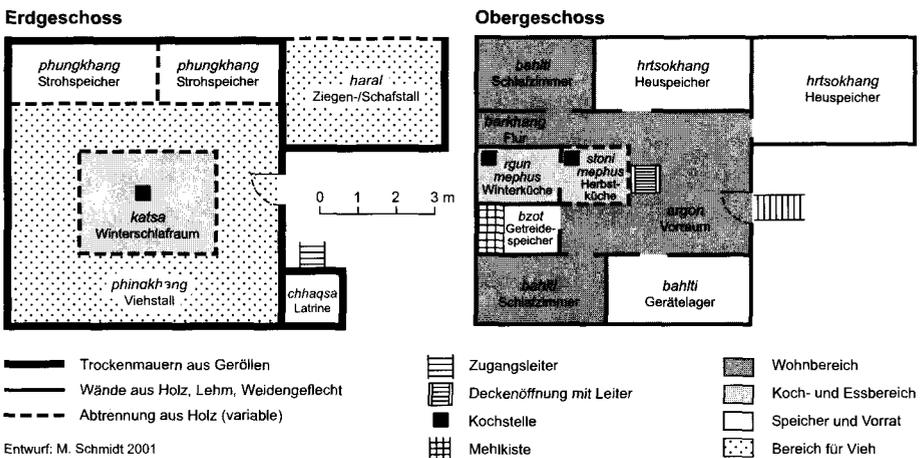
Grundriss eines lokaltypischen Wohnhauses (nang) in Shigar
